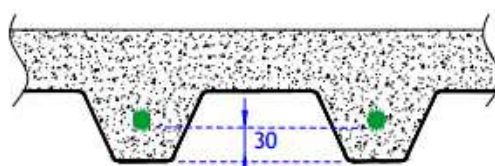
Disposição da armadura adicional para momentos positivos, (Fonte: COLABORANTE – Perfilagem de chapa, Lda, [41])
